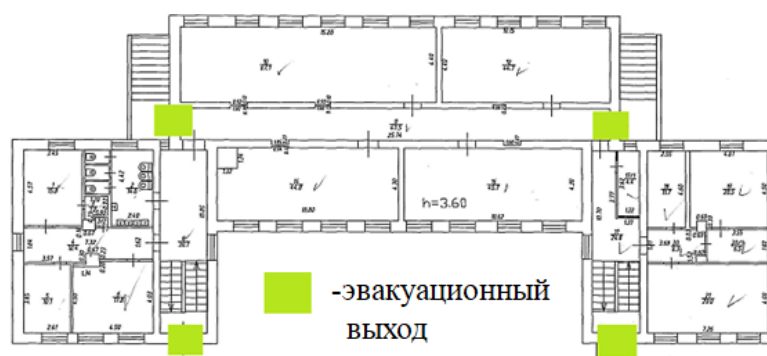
Расположение эвакуационных выходов на плане здания
